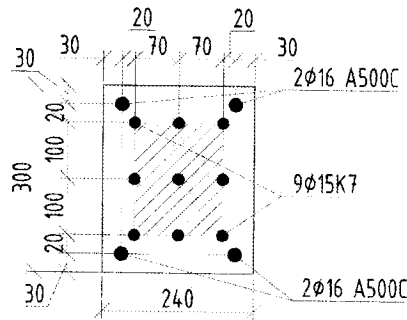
Схема розташування арматури в перерізі нижнього поясу ферми
